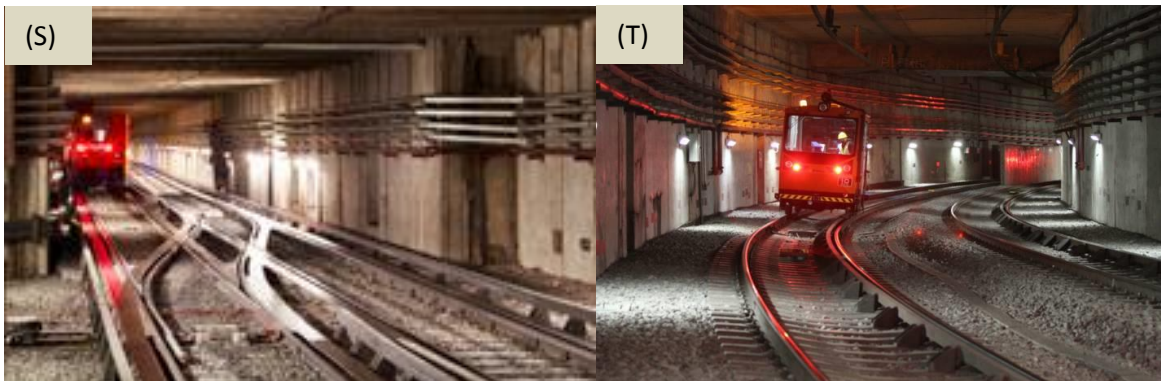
(S-T) “Cut and Cover” para la construcción del metro subterráneo en algunas zonas de la Cd. De México por medio de muro Milán colado *in situ* o prefabricado.
